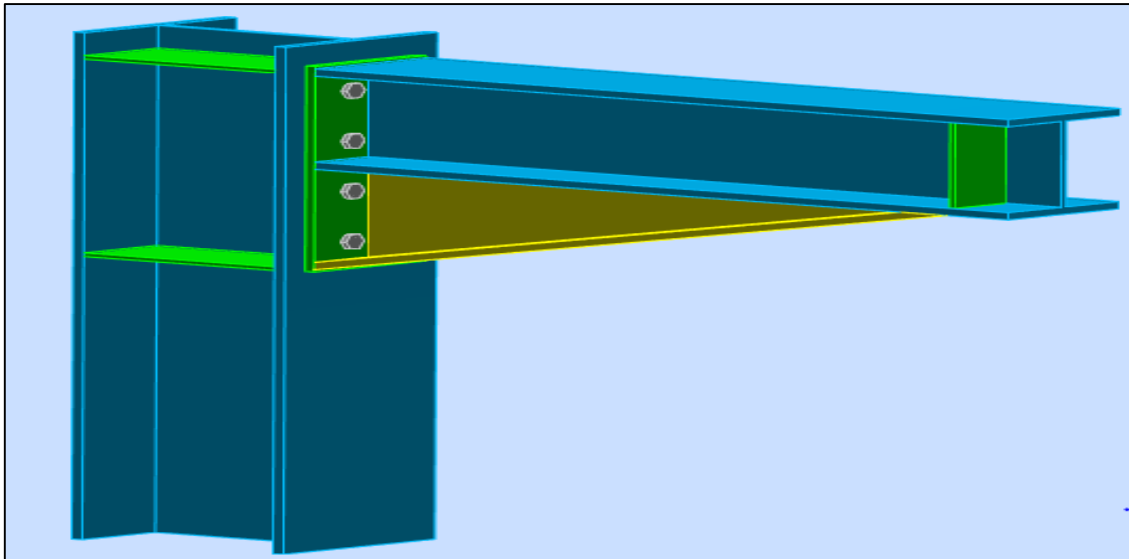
Vue en plan de l'assemblage poteau - console de la poutre de roulement.
